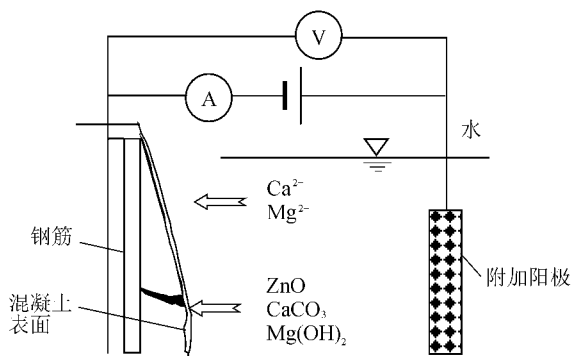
电沉积法修复钢筋混凝土裂缝原理示意图
